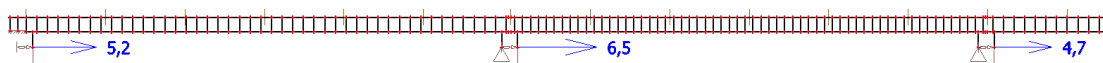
Posun okraje konstrukce v těžišti od svislého zatížení, pilíř 3, model 2
